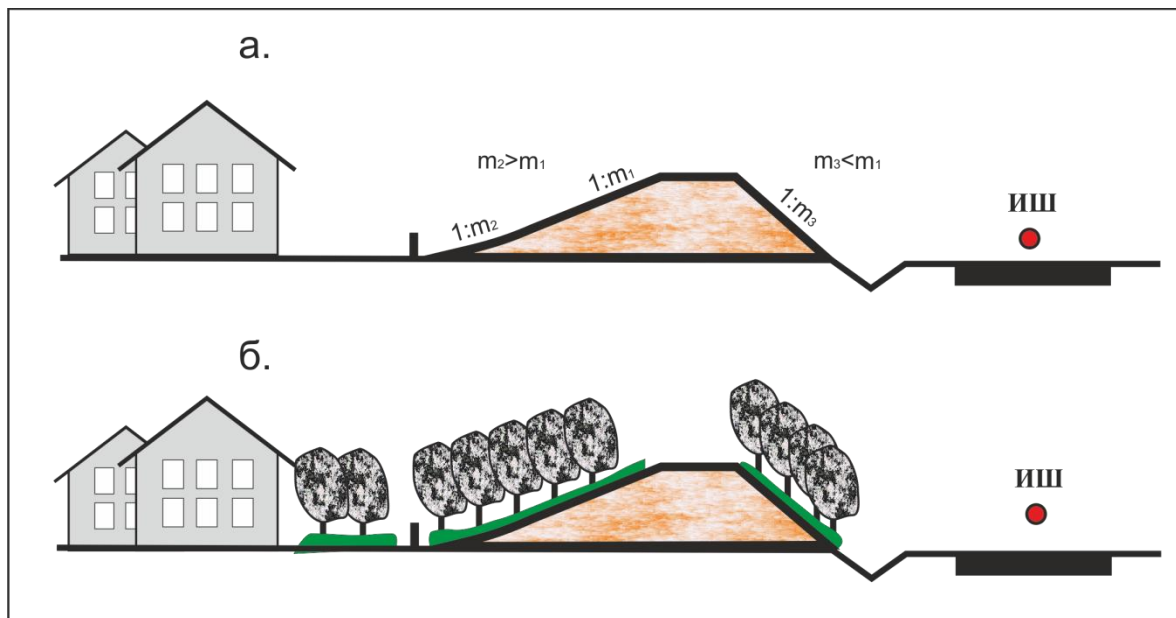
Схемы несимметричного шумозащитного вала (а) и его озеленение (б).
